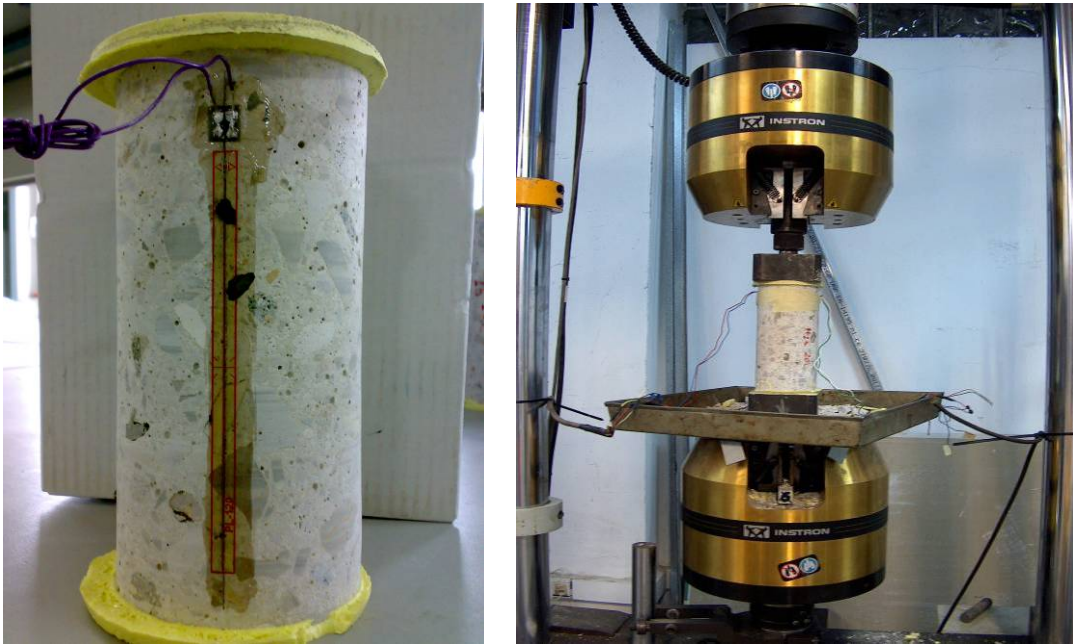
Testigo de hormigón reciclado instrumentado con galgas extensométricas, conectores y cableado (izq.), y dispuesto en la máquina dinámica de ensayo (dcha.).
